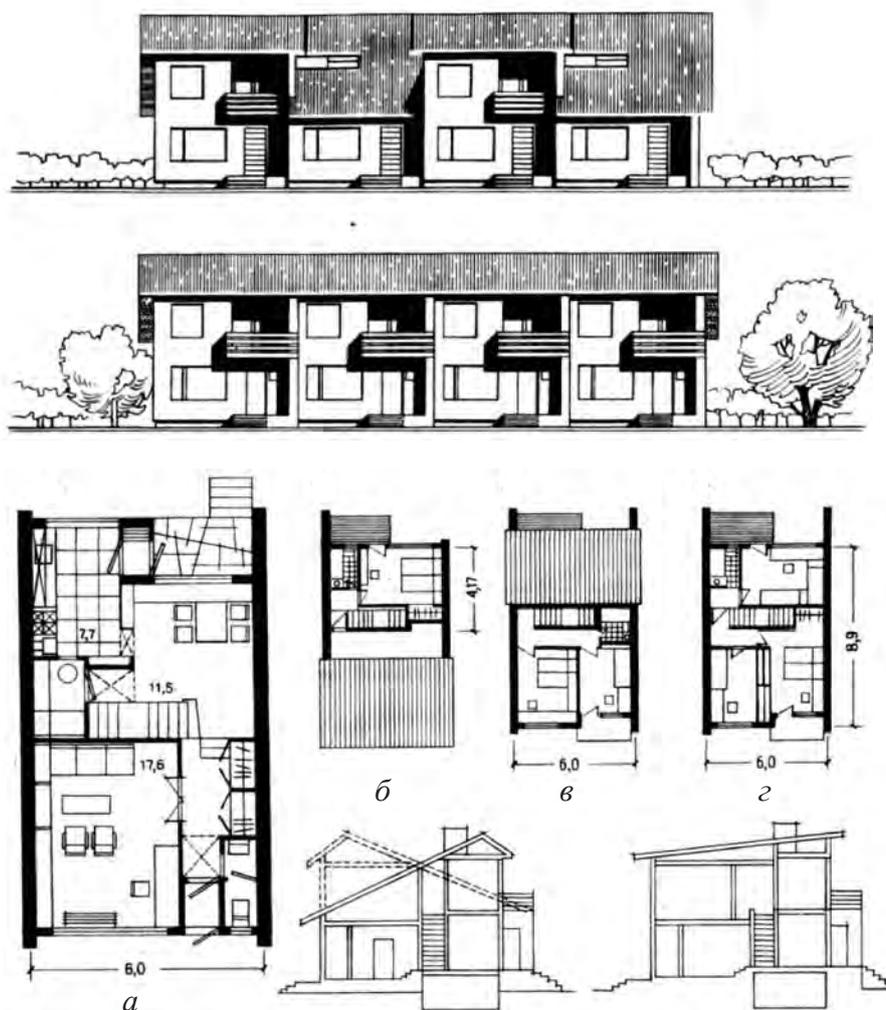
Серия блок-квартир с поперечными несущими стенами (конкурсный проект). Фасады, планы, разрезы: *a* — первый этаж, общий для всех блоков; *б* — двухкомнатная квартира; *в* — трехкомнатная квартира; *г* — четырехкомнатная квартира
